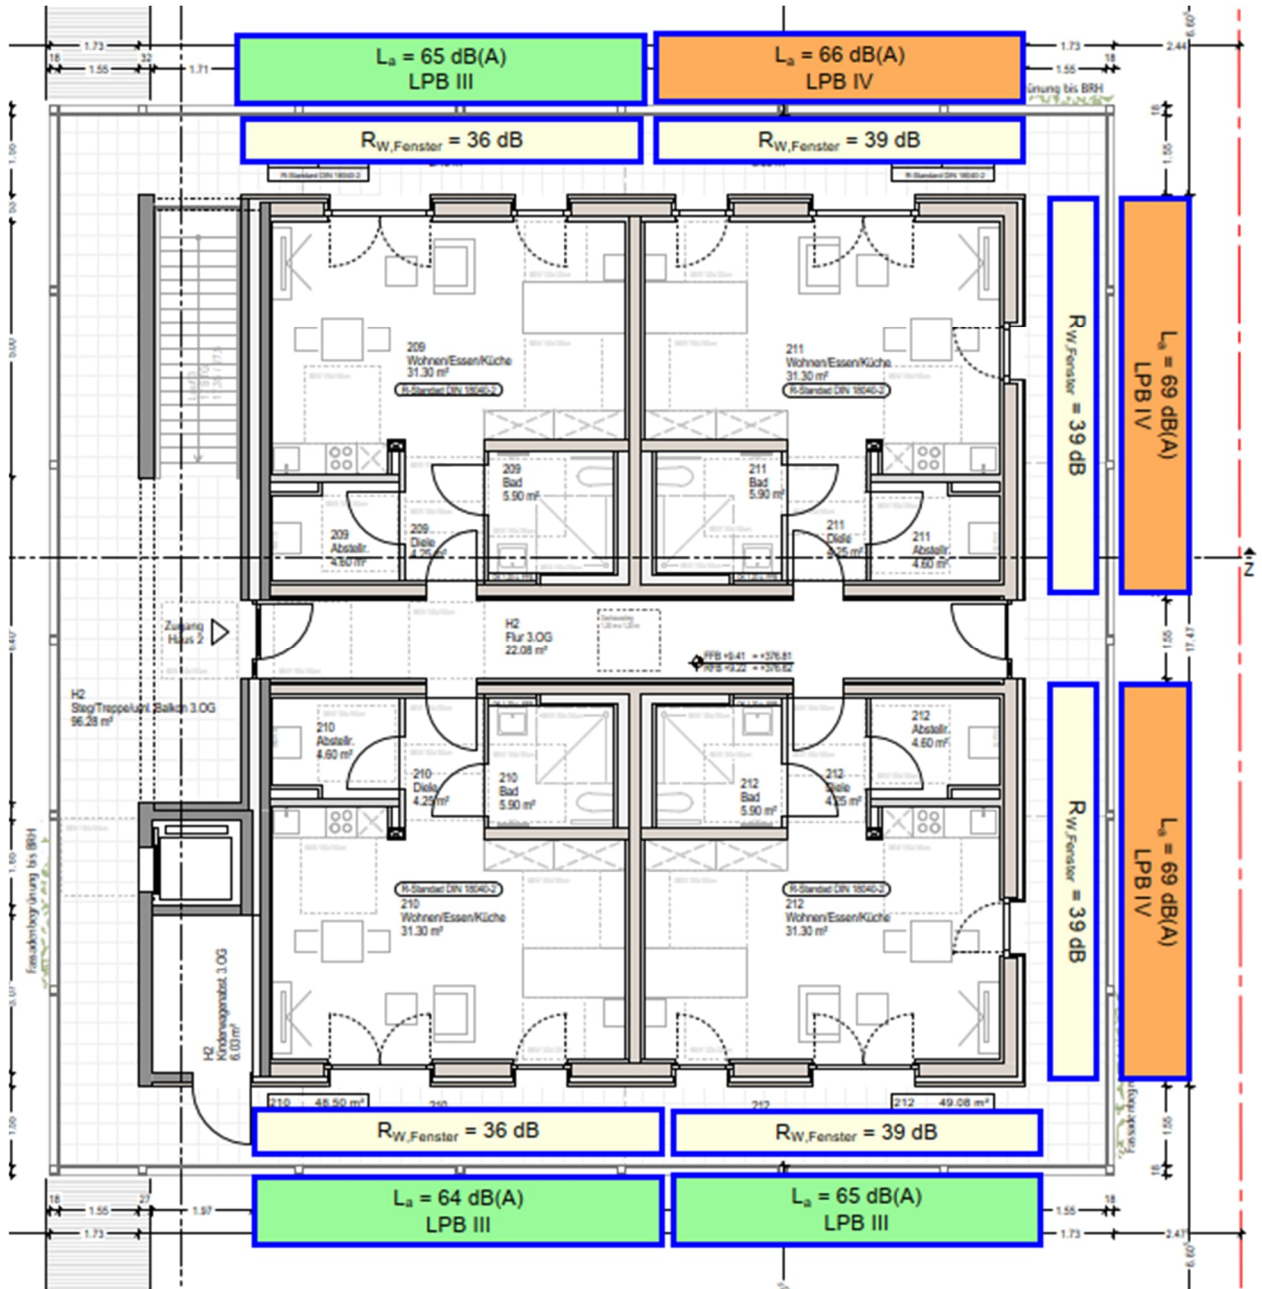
Außenlärm – Grundriss 3.OG – Haus 2
